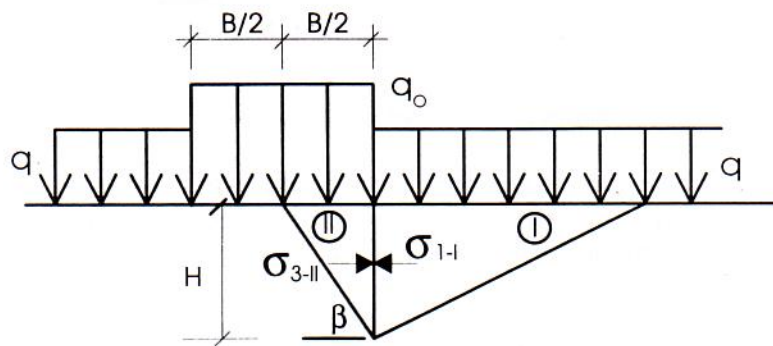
Disposición de las zonas plásticas bajo el cimiento.
